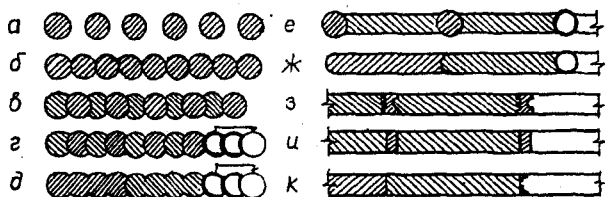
Конструкции монолитных свайных и траншейных стен
